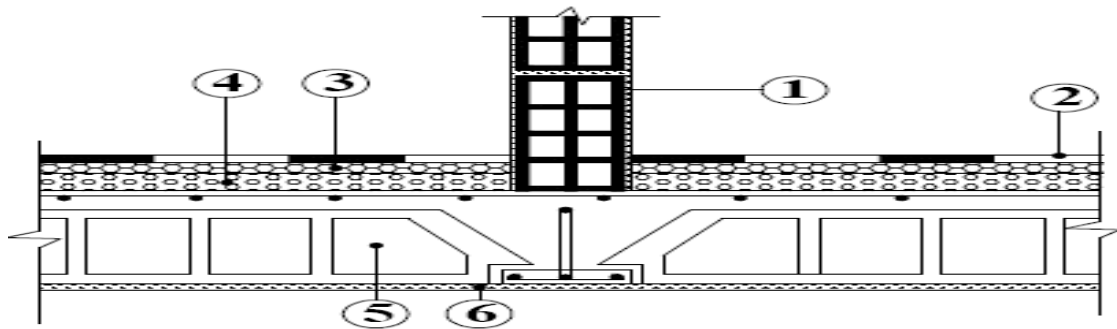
Coupe verticale d'un plancher d'étage courant
